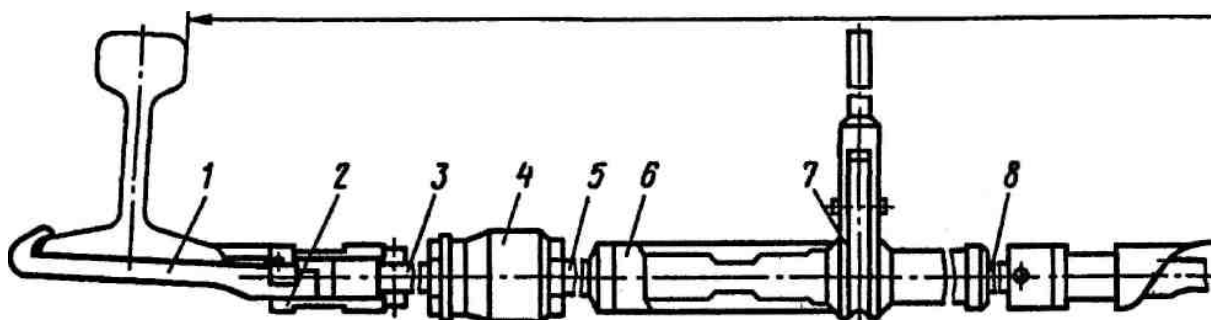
Стяжной прибор для регулировки ширины рельсовой колеи:
